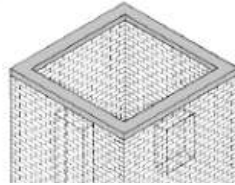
Système de chaînage au bout des murs qui stabilise la section (Carazas, s.d.)
